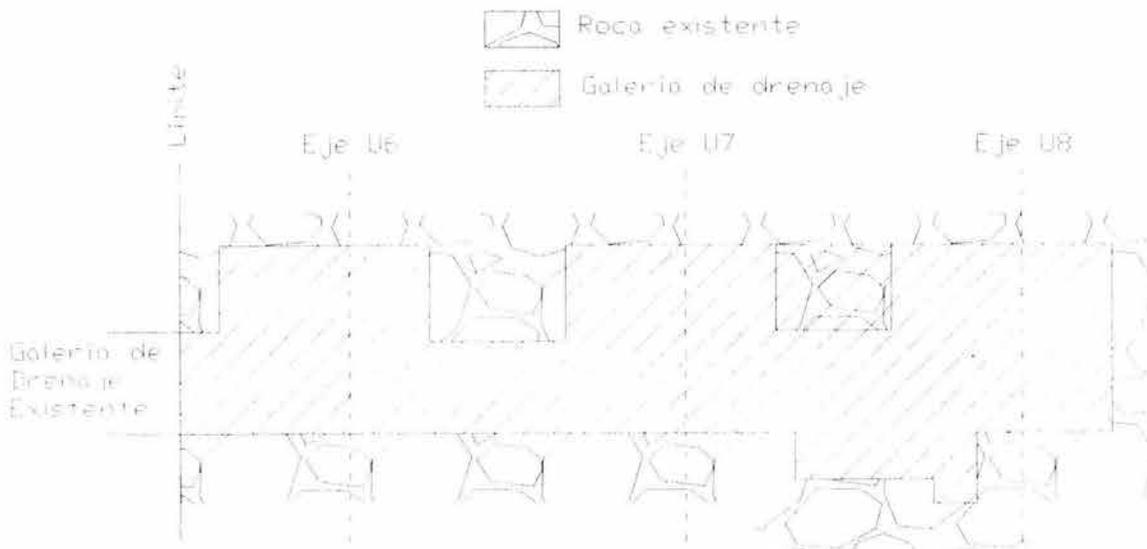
Vista en Planta de la Excavación en la Galería de Drenaje.
